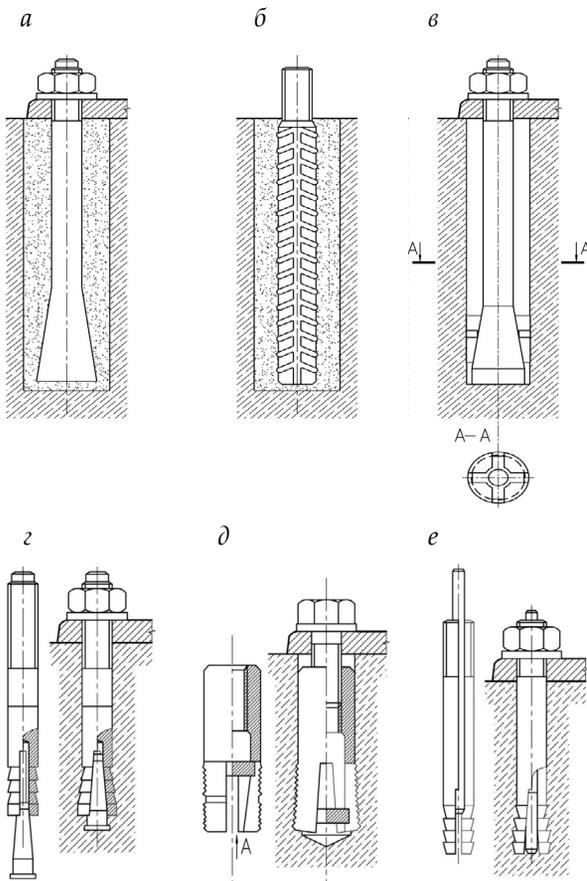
Устройство для закрепления опорного кольца подколонника к фундаментной железобетонной плите в виде анкерных болтов НИИЖБ (а, б, в) и/или самоанкерующихся дюбелей: дюбель-шпильки (г), дюбель с шайбой (д), дюбель-шпильки со штоком (е)
